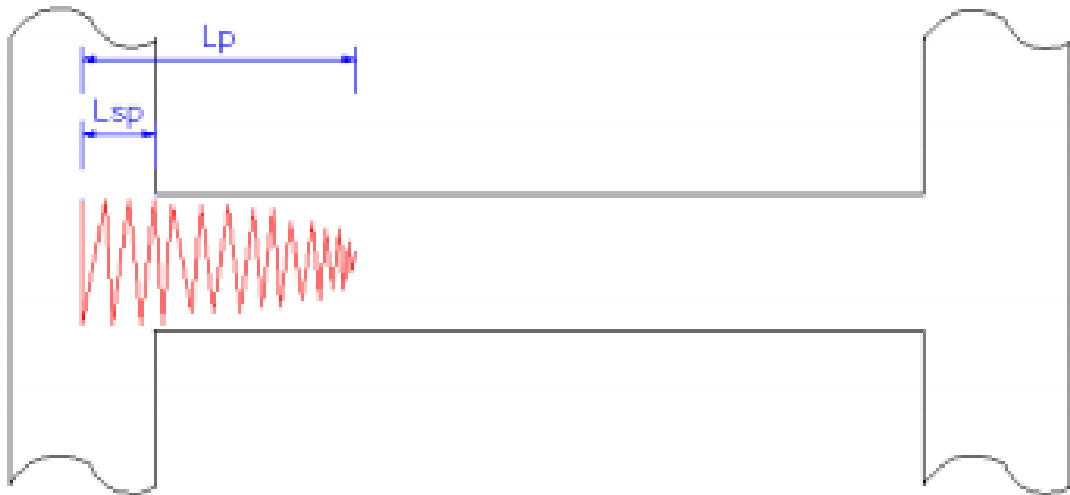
Formación de Rótula Plástica y Longitud de Penetración.
